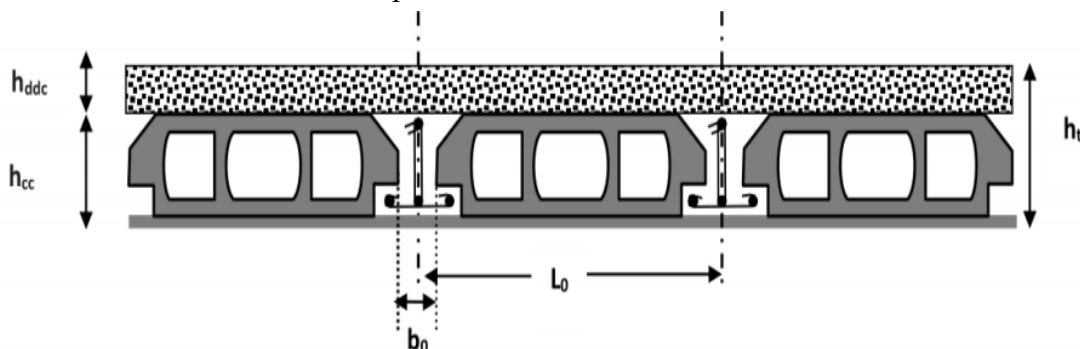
Coupe transversale sur un plancher à corps creux.
